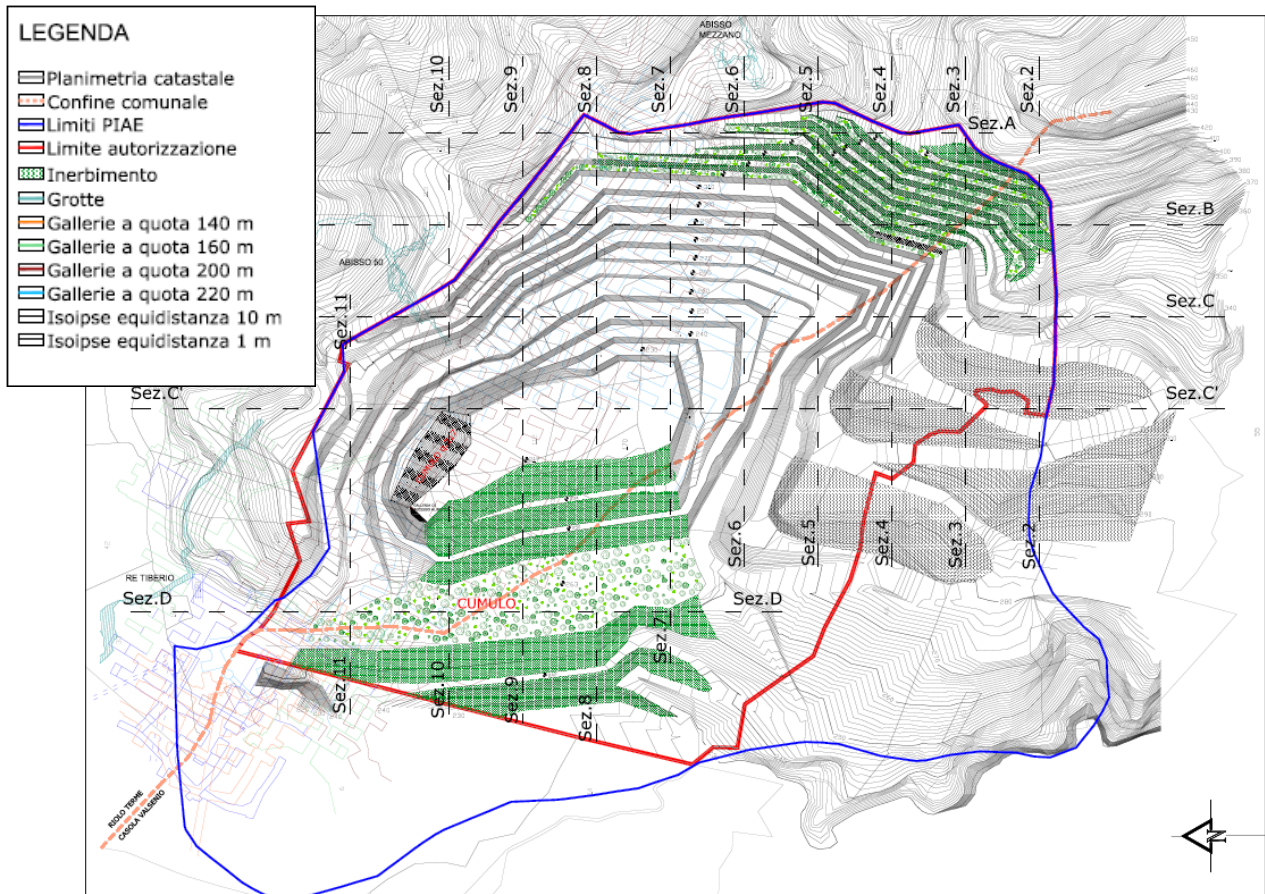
Planimetria dello stato di fine ripristino (Fonte: Saint Gobain S.p.A.)
